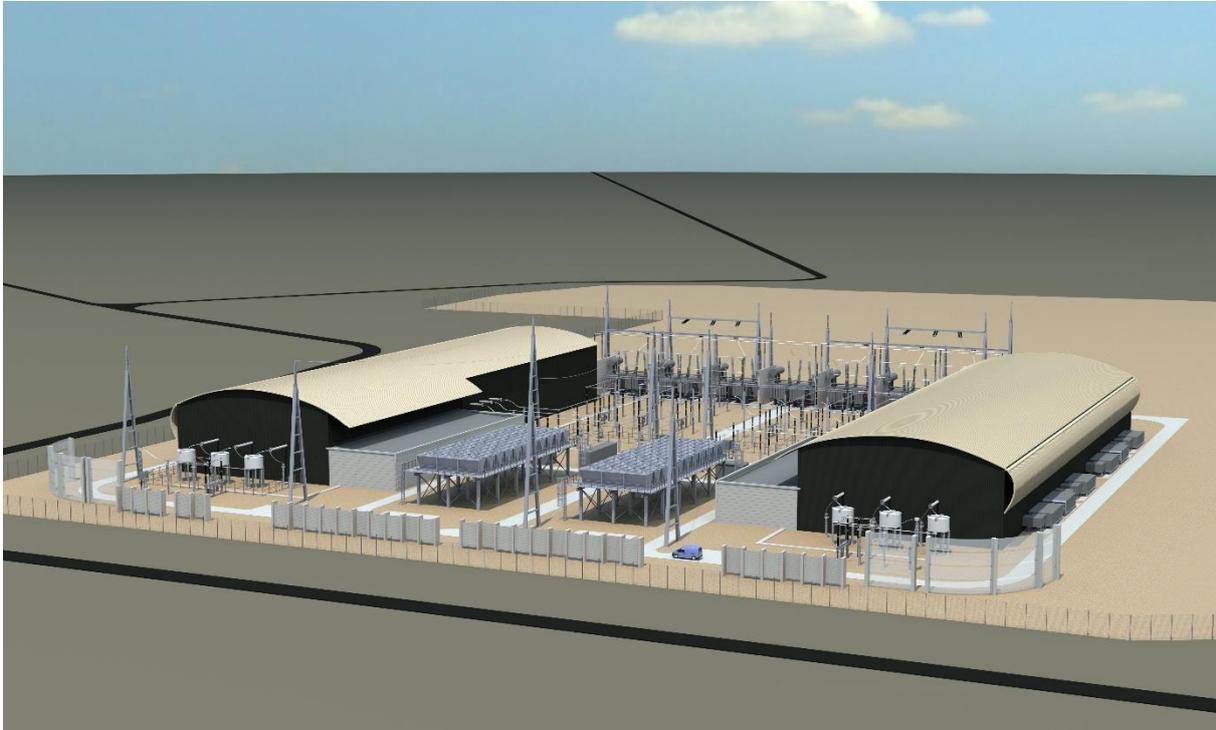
Exemple d'architecture d'une station de conversion existante (Baixas Santa Llogaïa)
